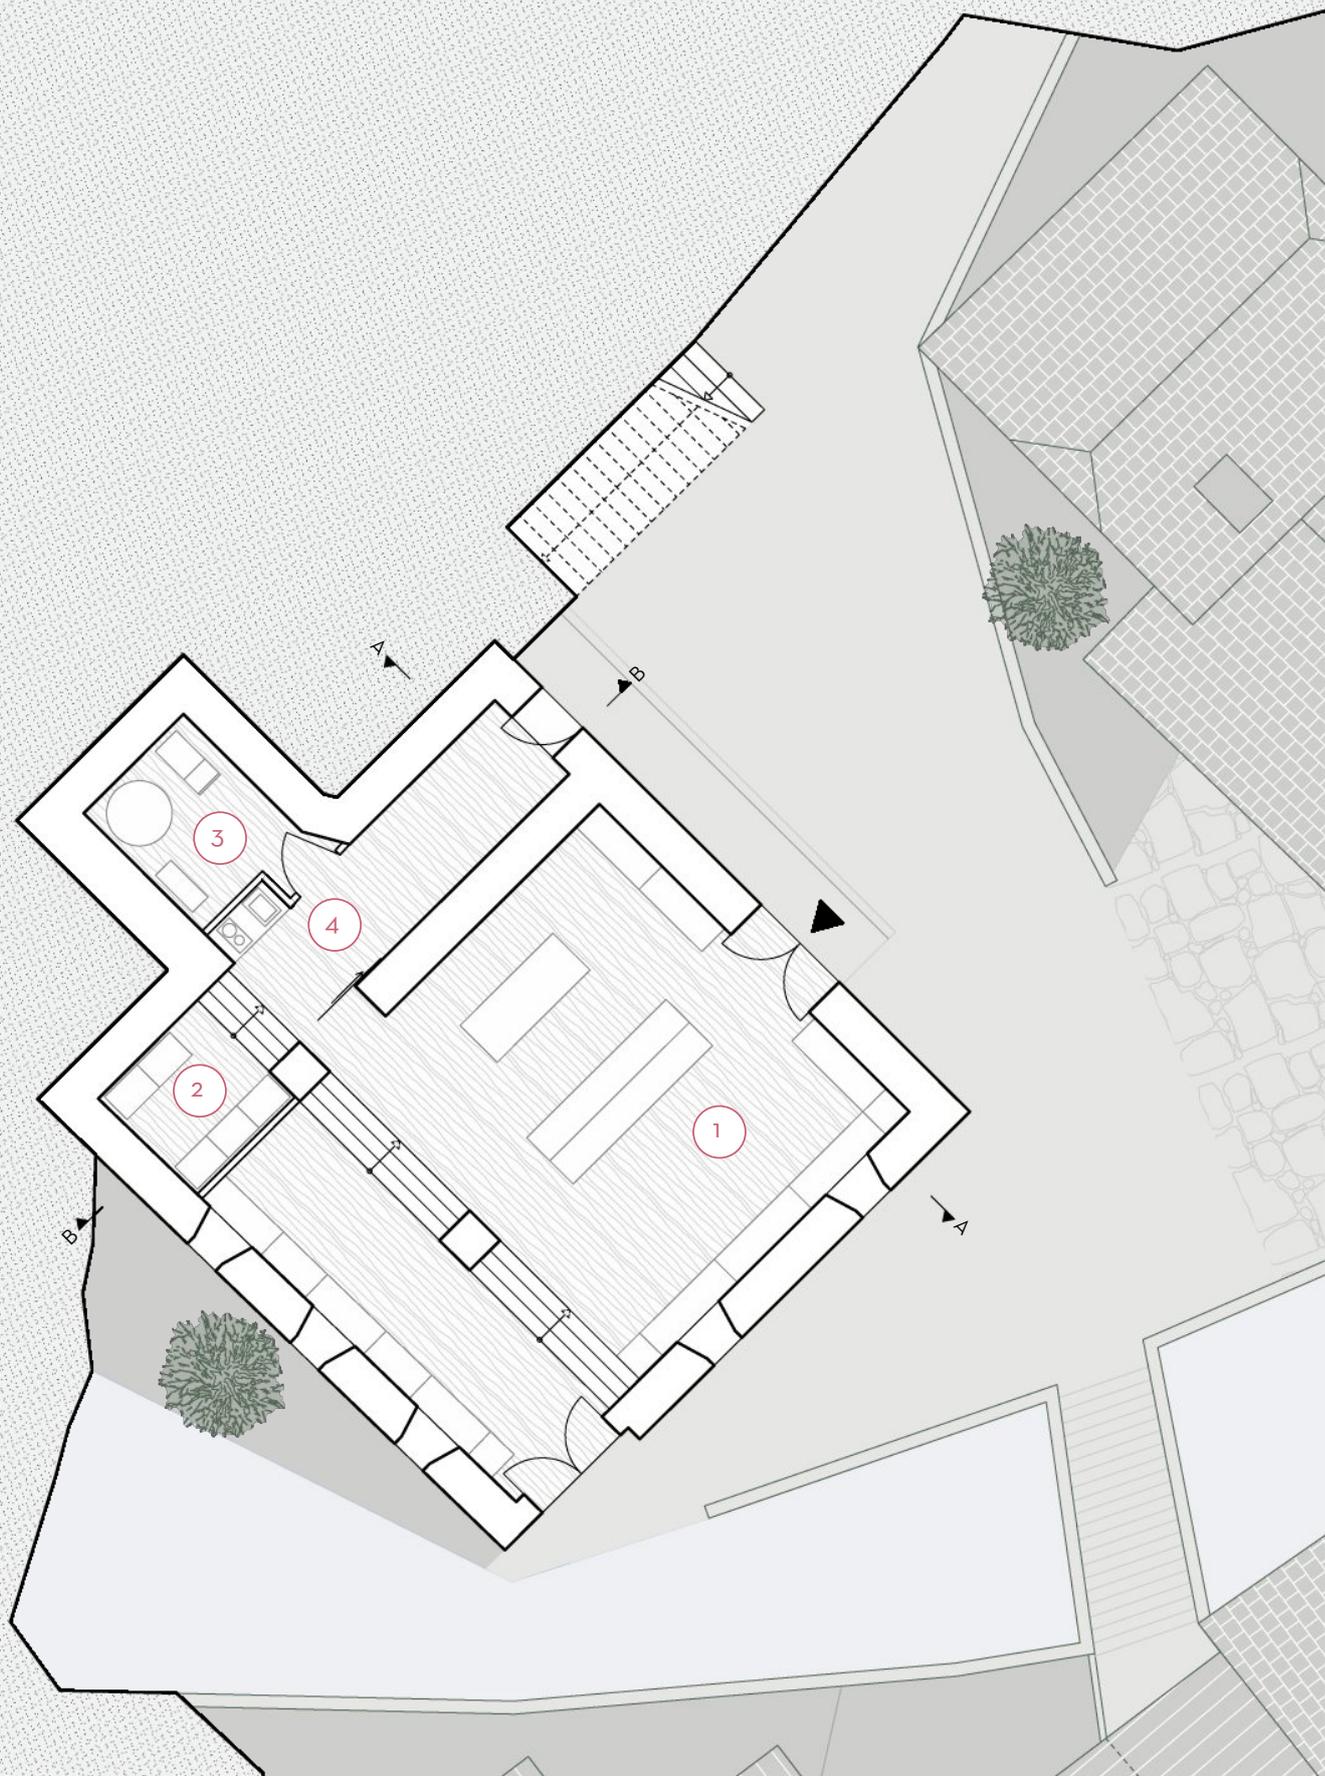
Grundriss Untergeschoss nach Umbau
